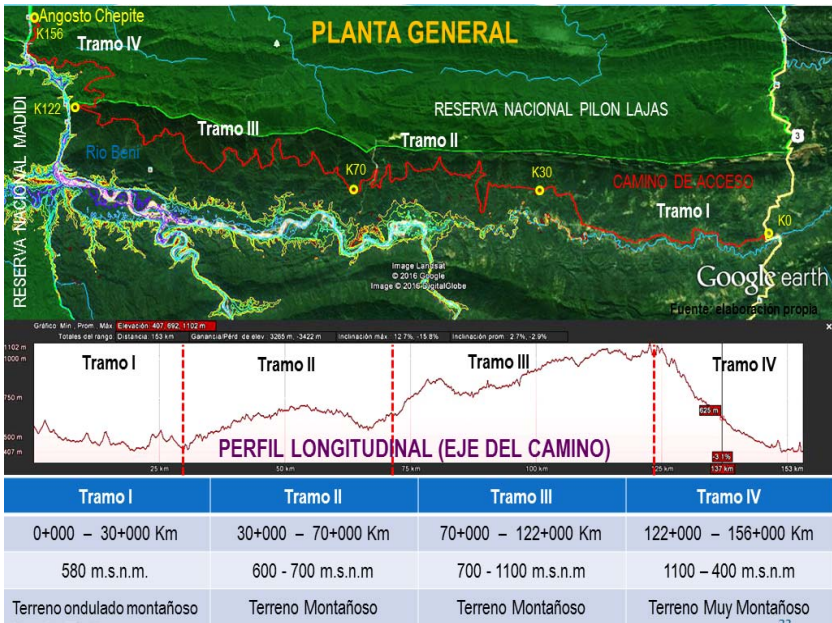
Trazo de camino de acceso, planta y perfil longitudinal
